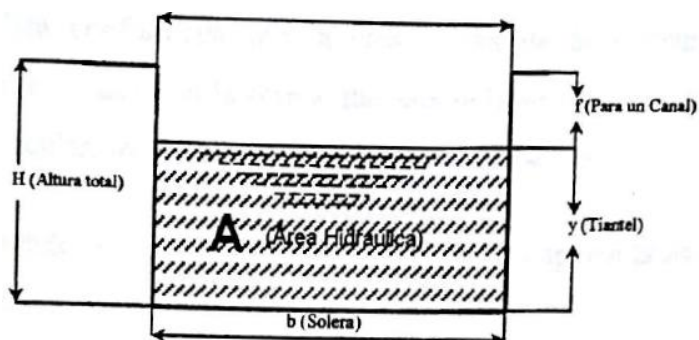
Sección rectangular de un canal (Fuente: Walter Morales Uchofen, "Infraestructura de Riego")
